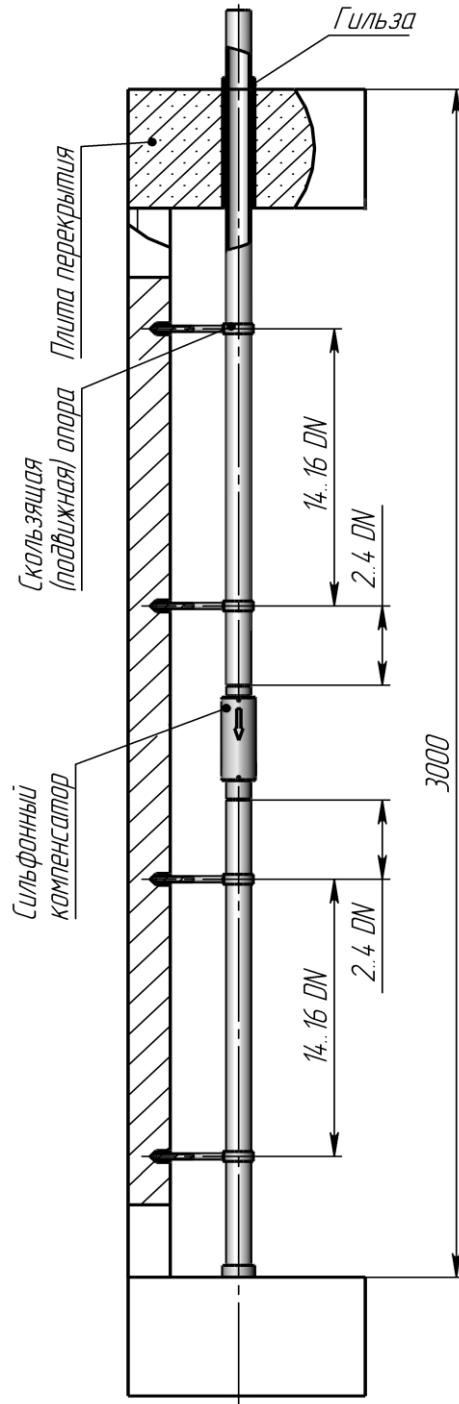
Расстановка подвижных опор при установке компенсатора по середине между перекрытиями.
